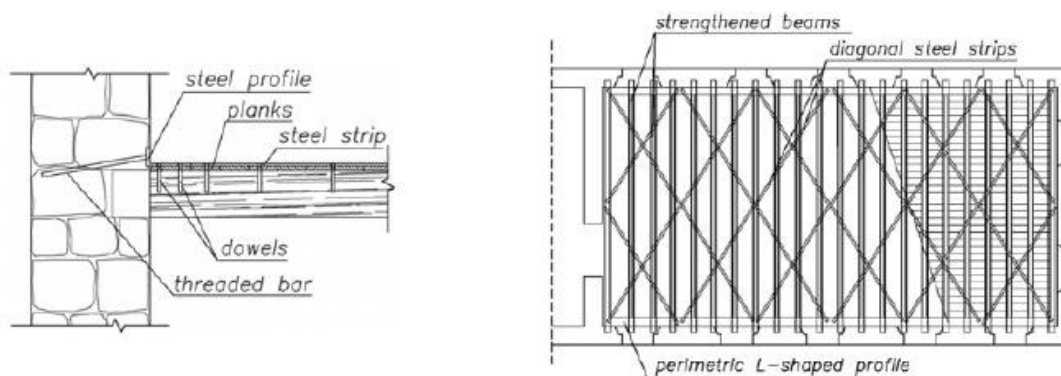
Ligação das chapas metálicas às paredes e vigas (à esquerda) e esquema da treliça metálica horizontal para reforço (Gattesco et al.;2006).
